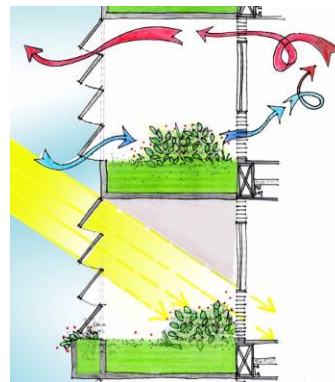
Esquema de ventilação e iluminação da Fachada Norte.
